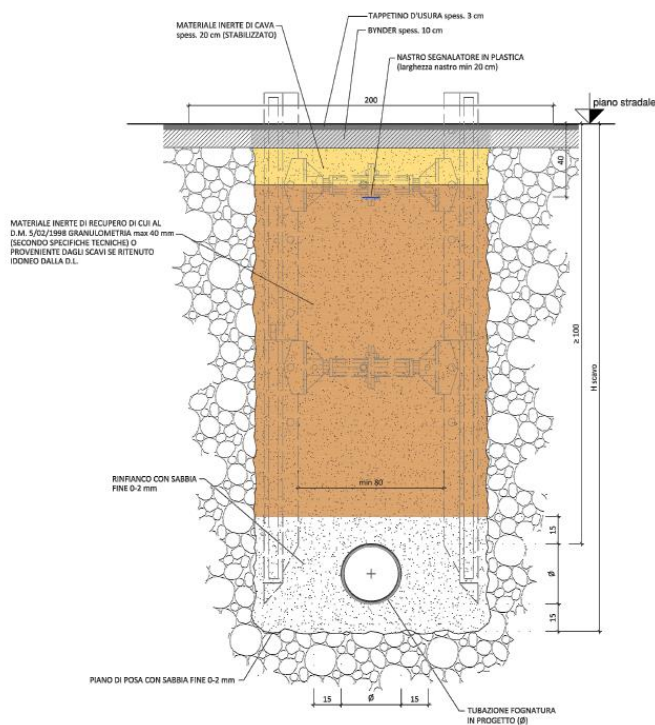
sezione tipo di posa e ripristino su viabilità stradale
